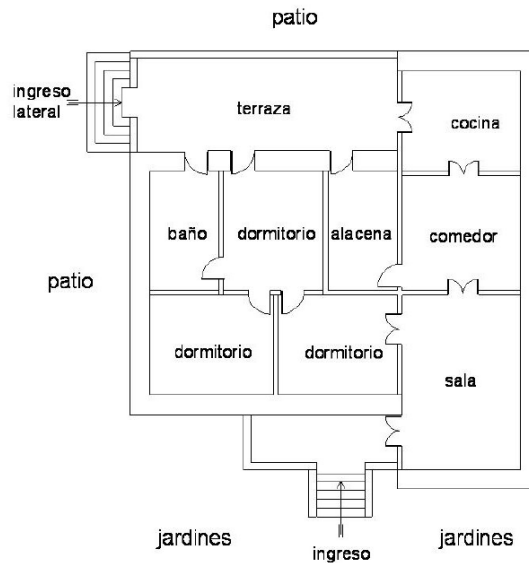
Ejemplo de planta esquemática, (SIPCE, INPC)
